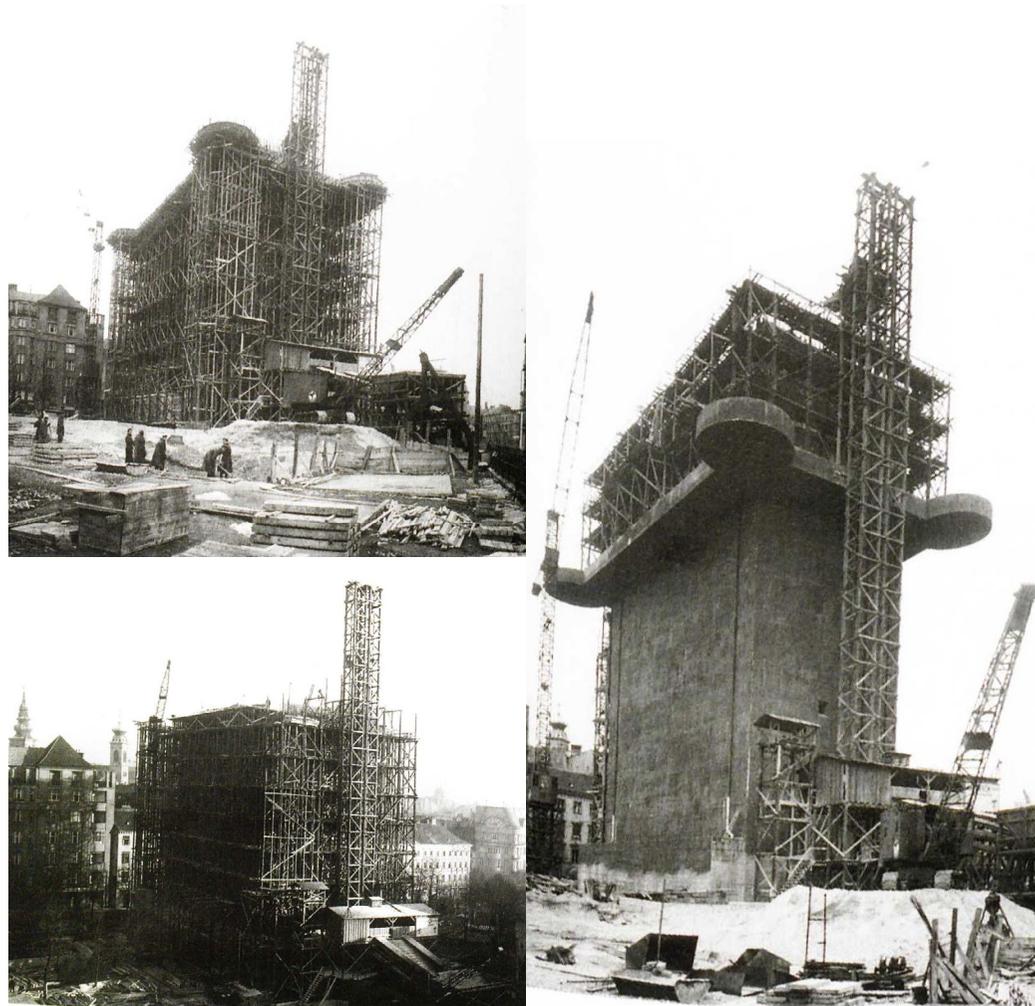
Foto storiche del cantiere della LV Esterhazy Park, primavera 1944.
